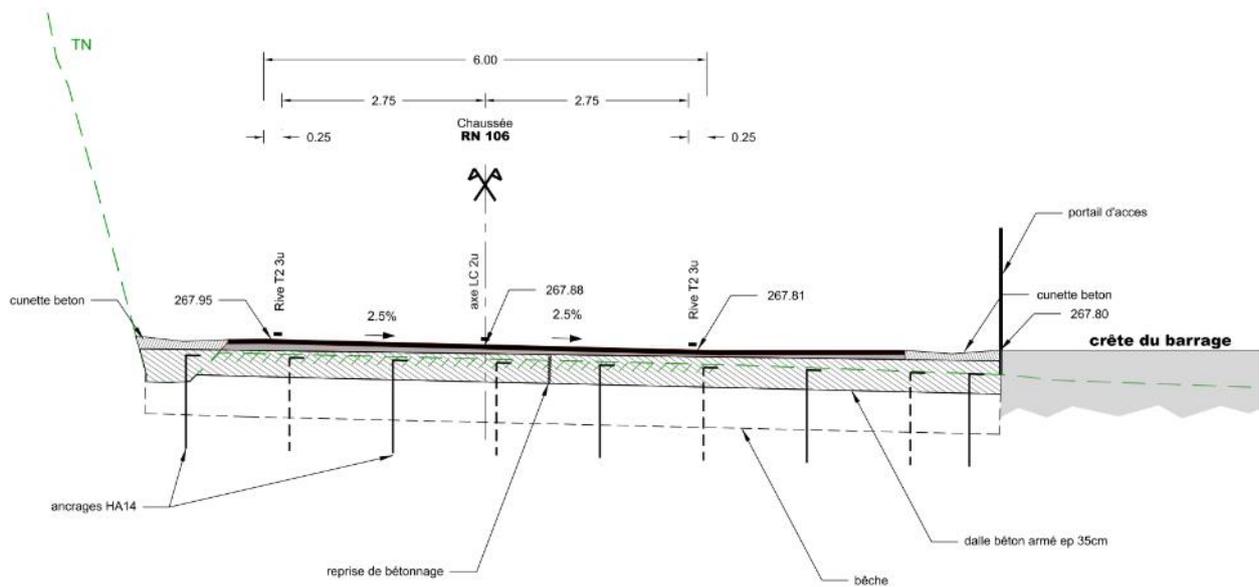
Coupe rive-rive de la dalle en béton sous la RN106 au droit du barrage
